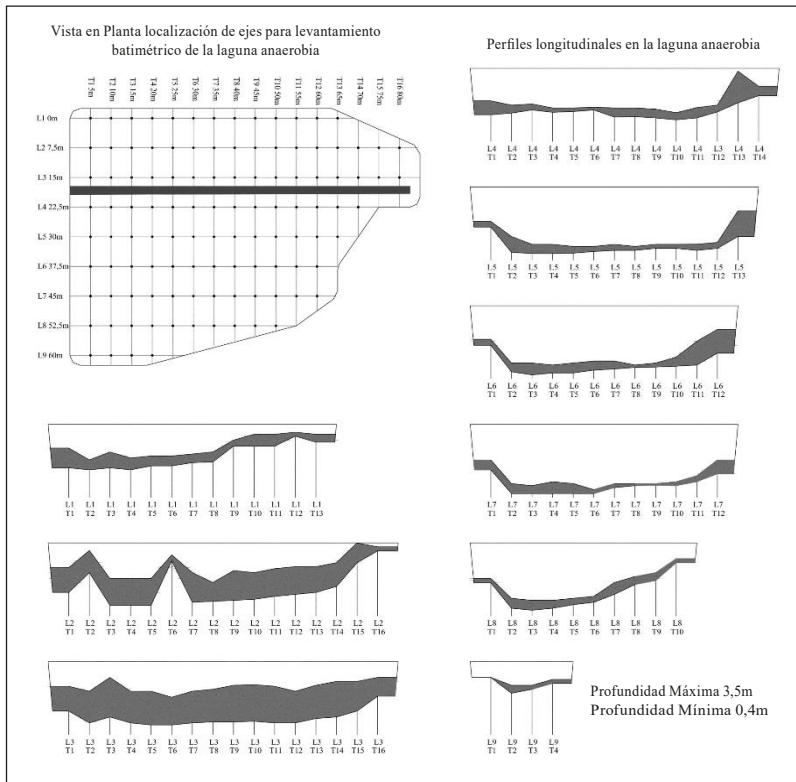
Vista en planta y perfiles longitudinales de la laguna anaerobia
